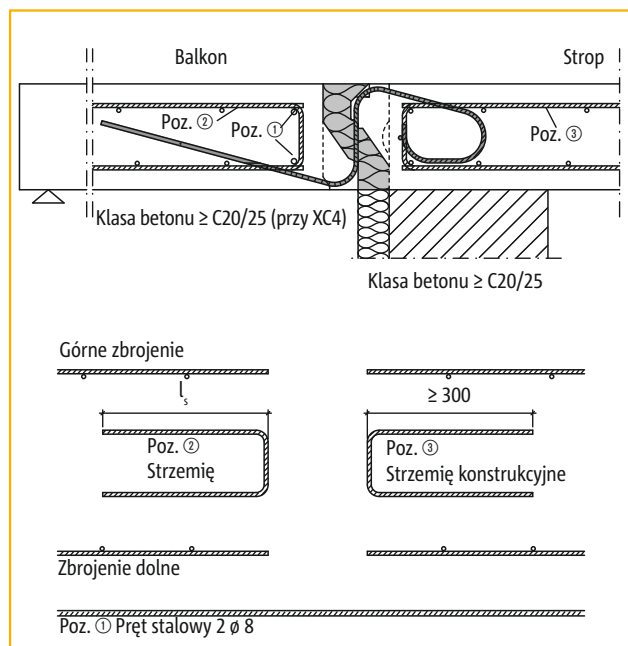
Montaż płyty balkonowej jako element prefabrykowany przy pomocy Schöck Isokorb® typu V6/6
